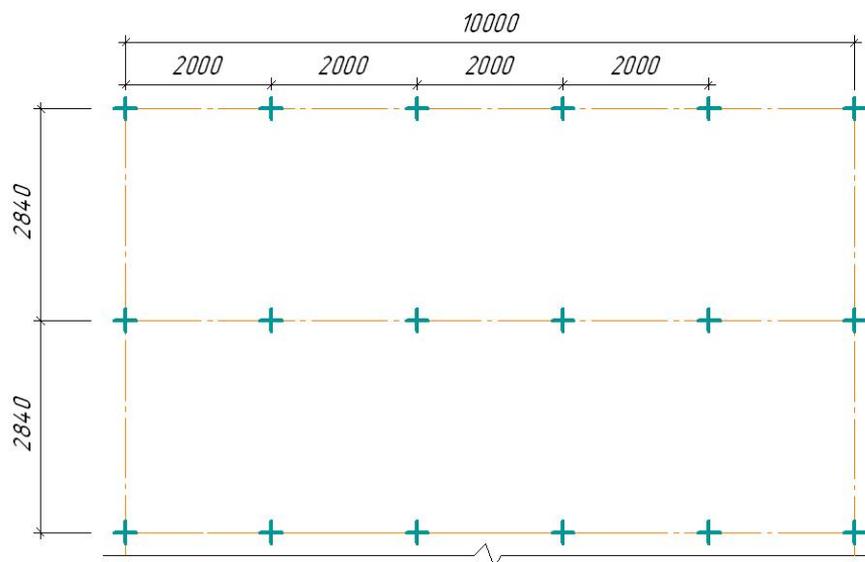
Схема плана свайного поля под модульное здание длиной 10 м
